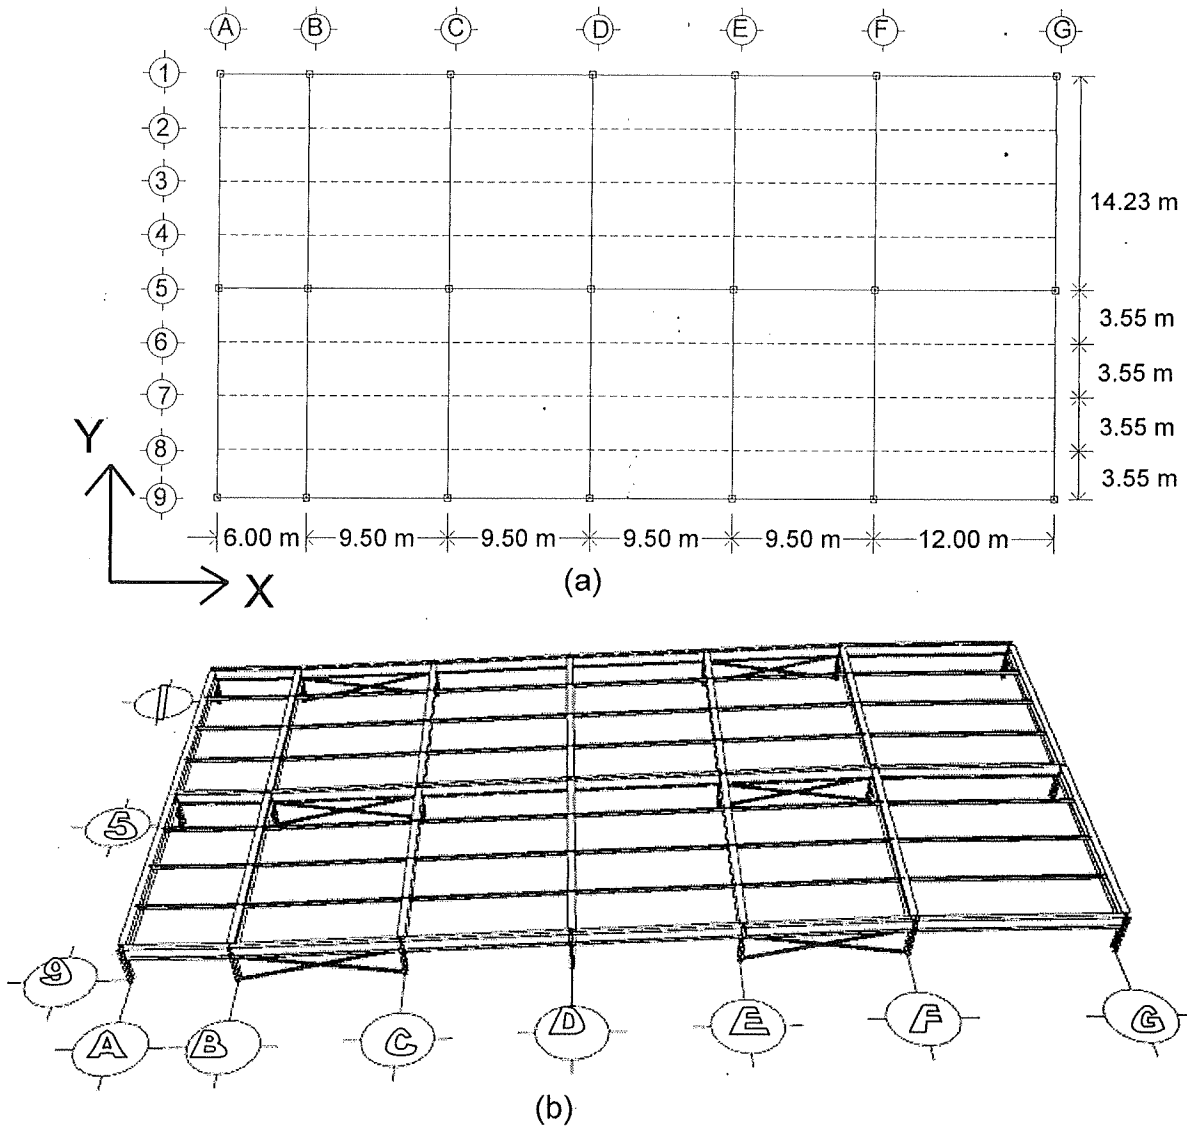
(a) Planta estructural de la sección A, (b) Edificio en 3D.
